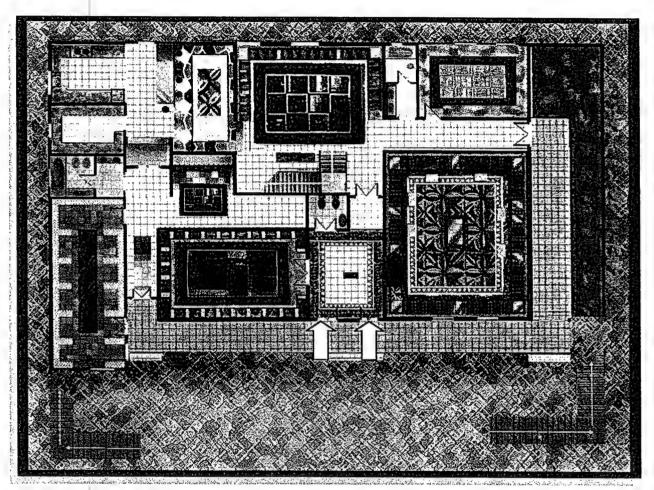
مسقط أفقي للدور الأرضي (نموذج رقم ٢)
